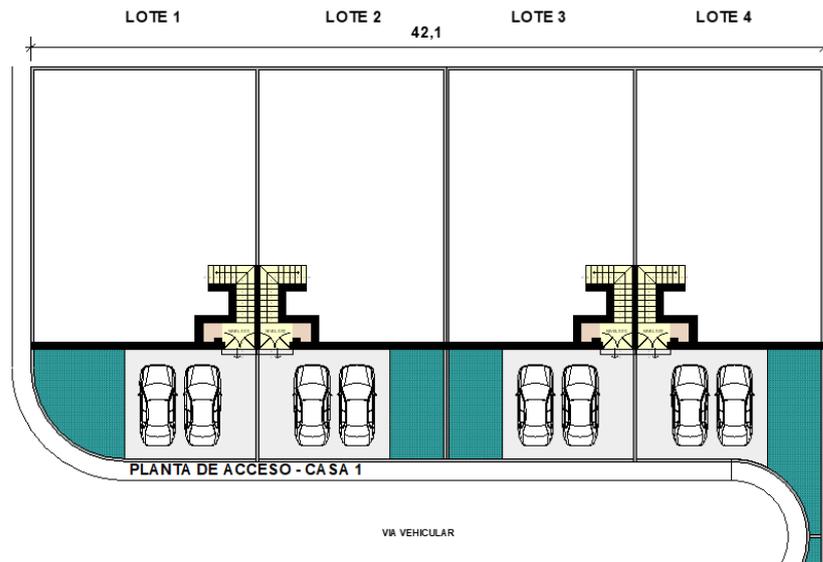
Plano 2 Planta acceso casa tipo I. Fuente: Construvicor Cia. Ltda.
